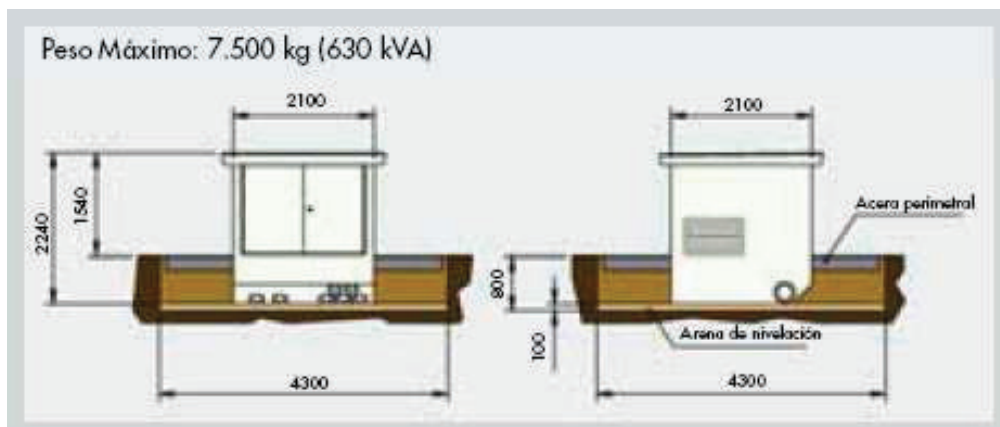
Aparamenta de MT yBT de un MINIBLOK
